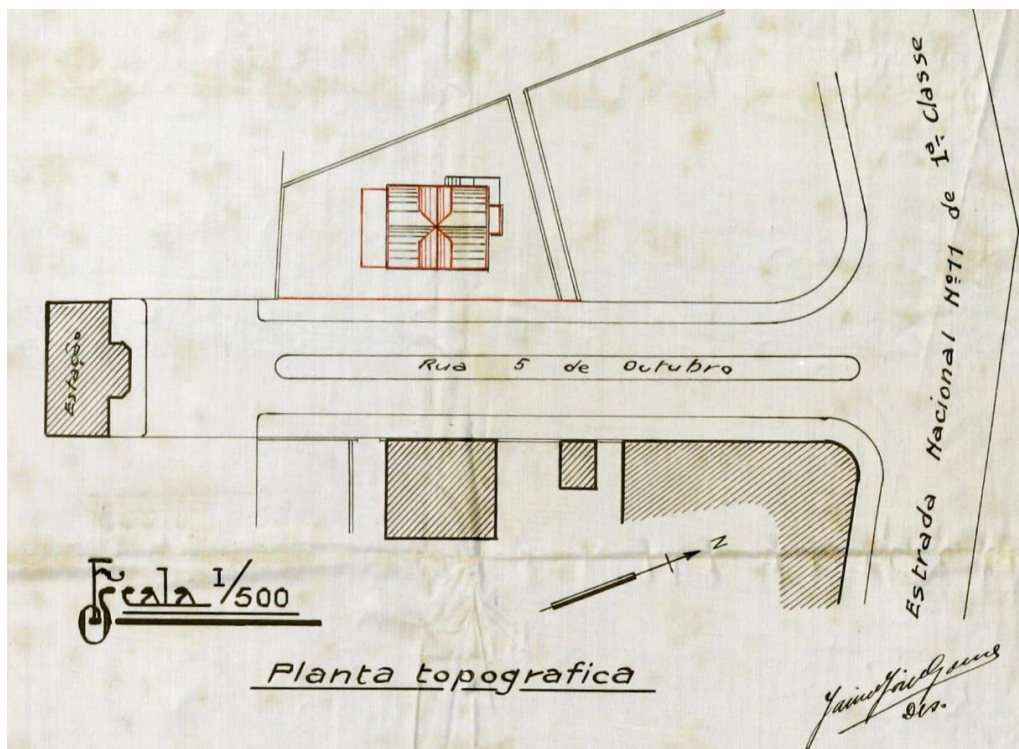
[extrato] Planta topográfica com localização do edifício (Anexo 5)
